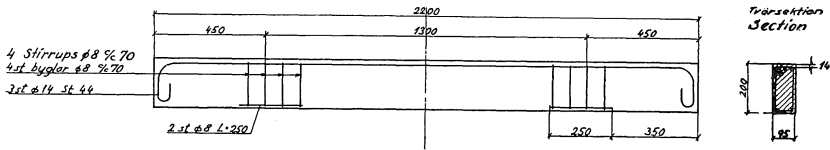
Dimensioner och armering hos provbalkar i serie III.
